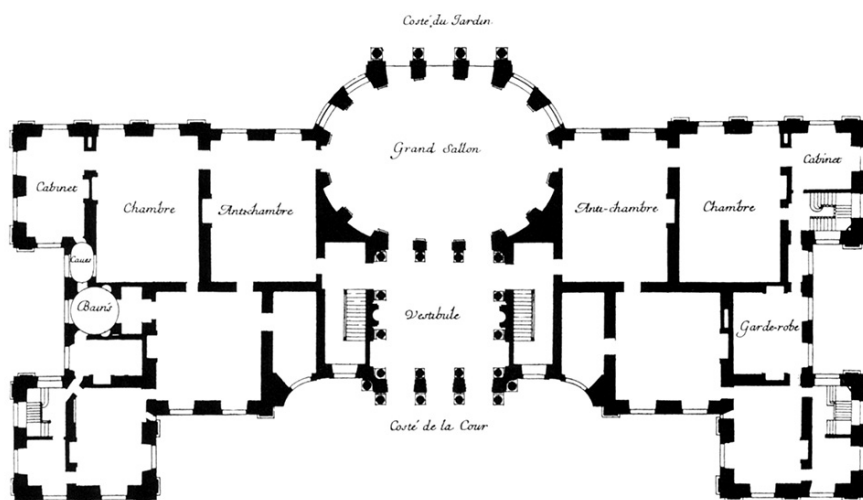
Hôtel de la Vrillière, plan przyziemia.
